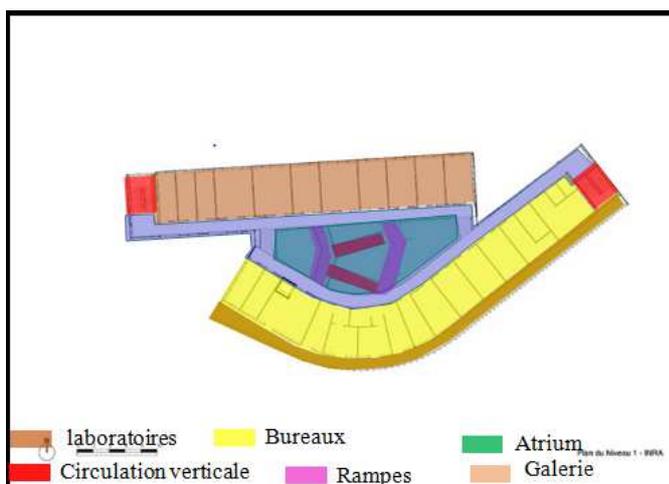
Plan du 1^{er} étage. Source : <http://www.archdaily.com>
